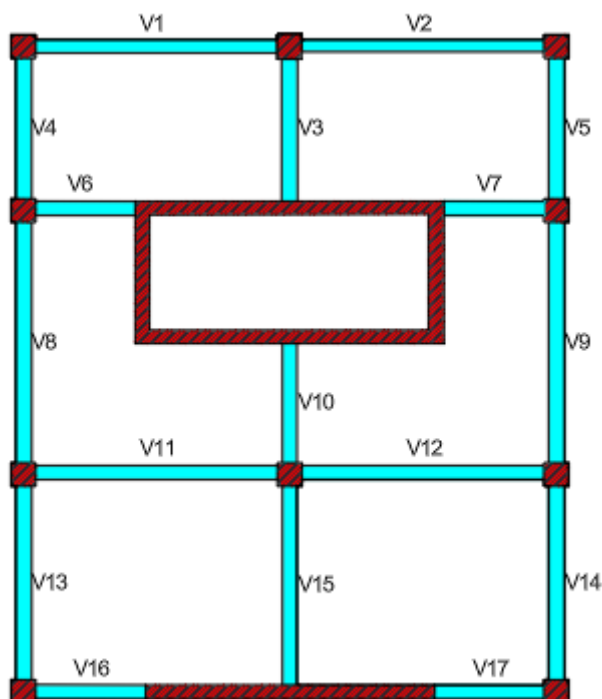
Planta-tipo das vigas sísmicas primárias do edifício
